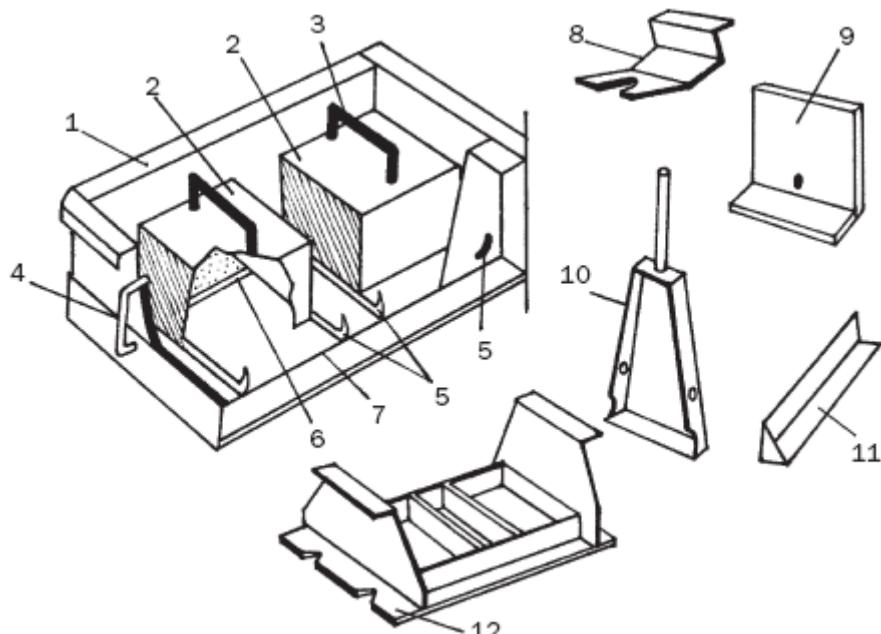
Форма для изготовления блоков ТИСЭ: 1 – форма; 2 – съемные пустотообразователи; 3 – ручка; 4 – продольный штырь; 5 – поперечный штырь; 6 – уголок-распорка; 7 – несущая рама; 8 – скребок; 9 – перегородка; 10 – трамбовка; 11 – уголок с торцевой перемычкой; 12 – выжимная панель
